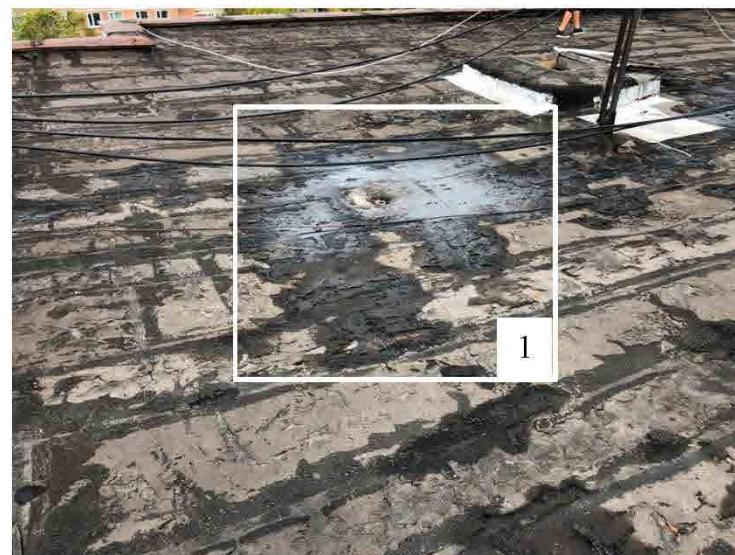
Фрагмент вида кровли. Дефекты: 1 – застой воды.
